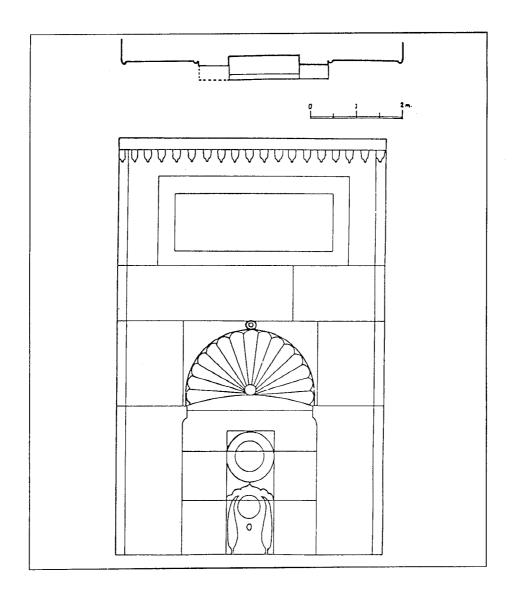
مسقط أفقي لچشمة گلبهار خاتون أدرنة (عن :Ö N G E) .
